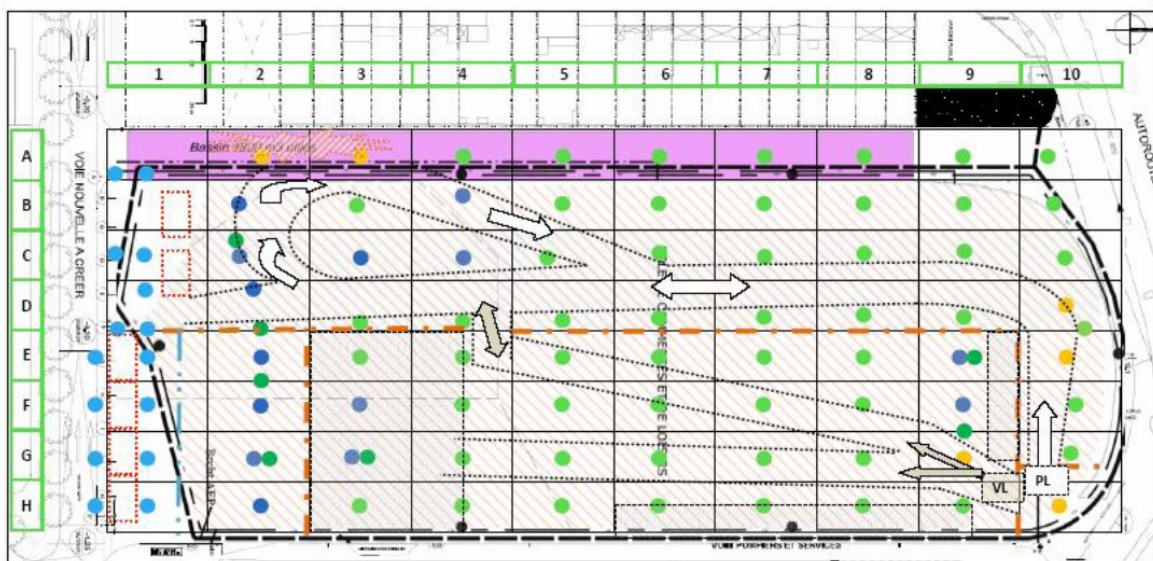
Schéma d'implantation des sondages réalisés par ANTEA GROUP en mai 2011 et principaux éléments structurants du site ayant conduit à adapter le plan prévisionnel d'investigations de terrain
